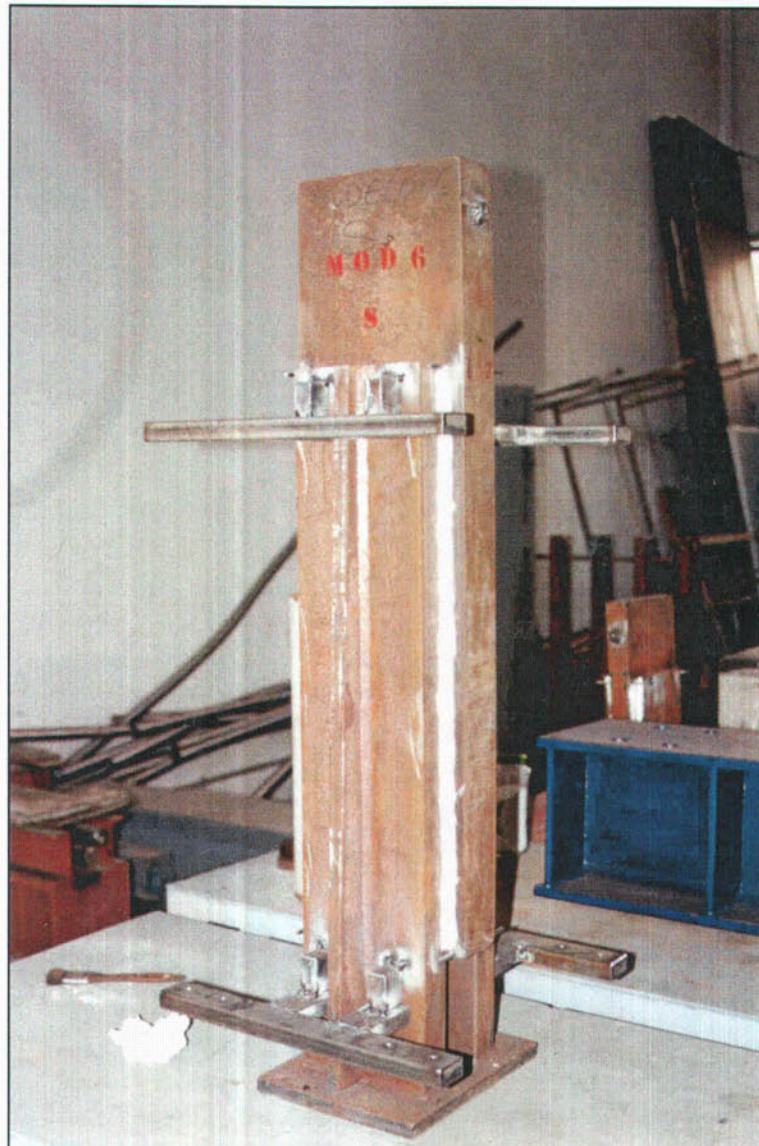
Detalle de la probeta 6S tras el ensayo. No llegó a romper, manteniéndose la cal casi intacta sobre las soldaduras, señal de que no llegaron a plastificar apenas.
